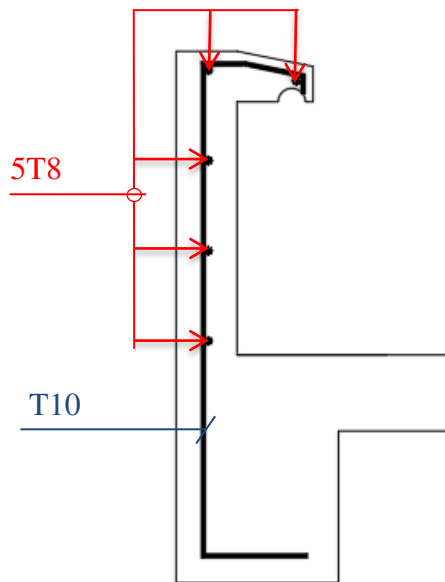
Schéma de ferrailage de l'acrotère.
